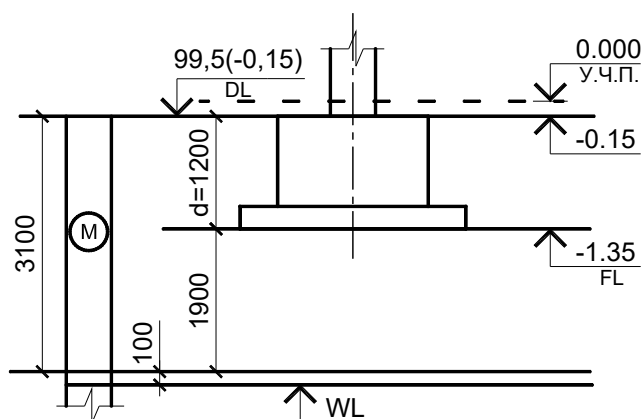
Определение предварительной глубины заложения фундамента к примеру 5
